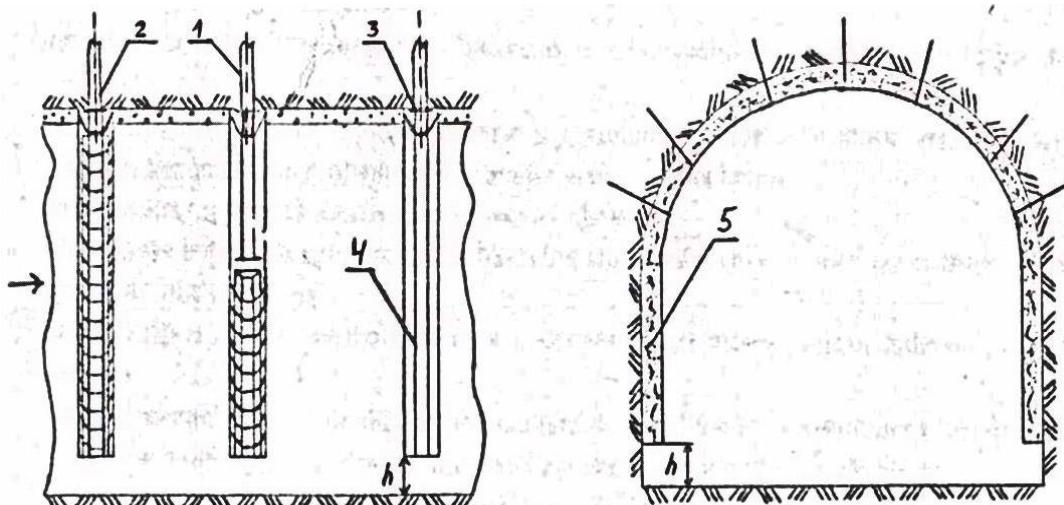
Схема виробки з комбінованої податливою кріпленням: 1 – опорна шайба, 2 – трубчастий анкер, 3 – торець, 4 – залізобетонне аркове кріплення, 5 – шар набризкбетону
